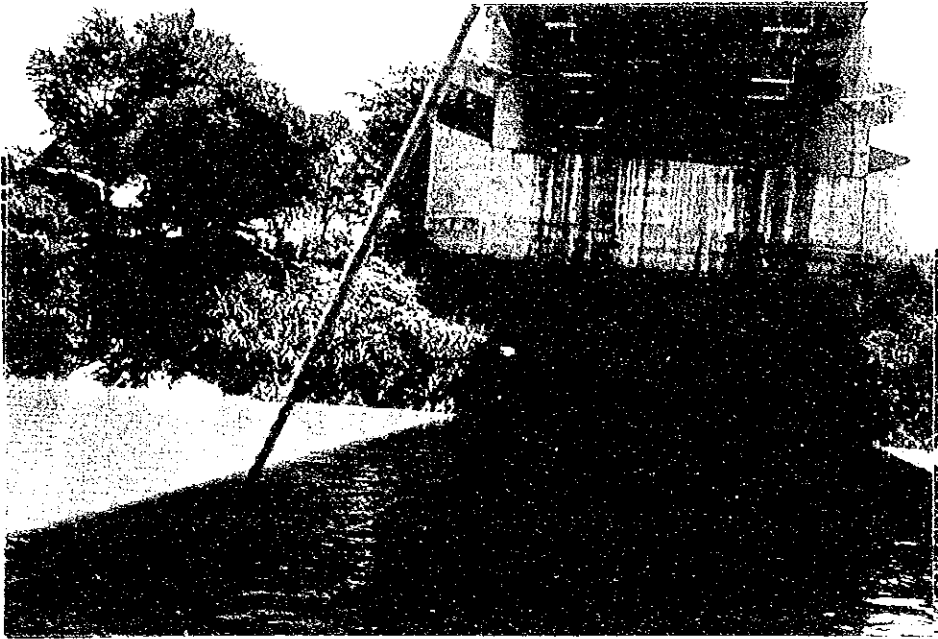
チュルイ・チョンバー側 P 8橋台支持層の侵食
